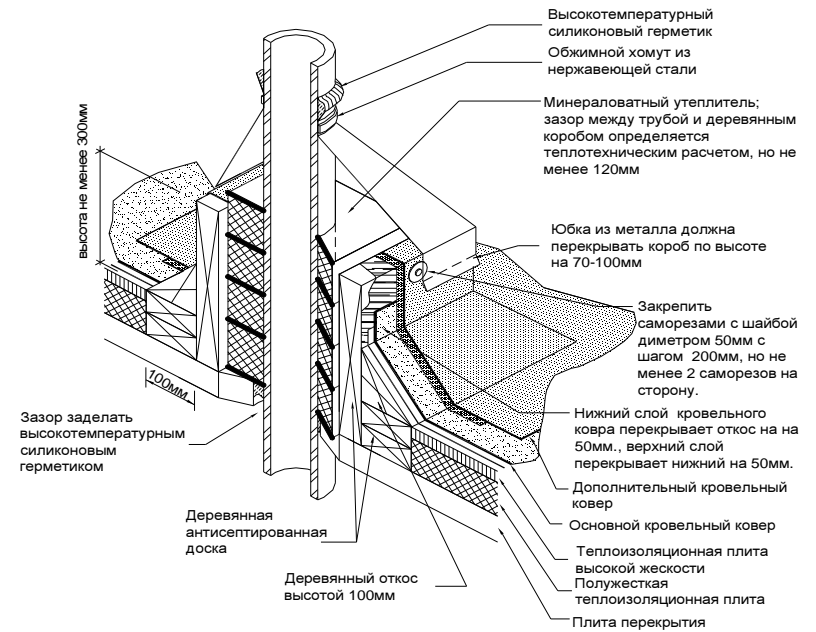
Примыкание кровельного ковра к горячей трубе.
